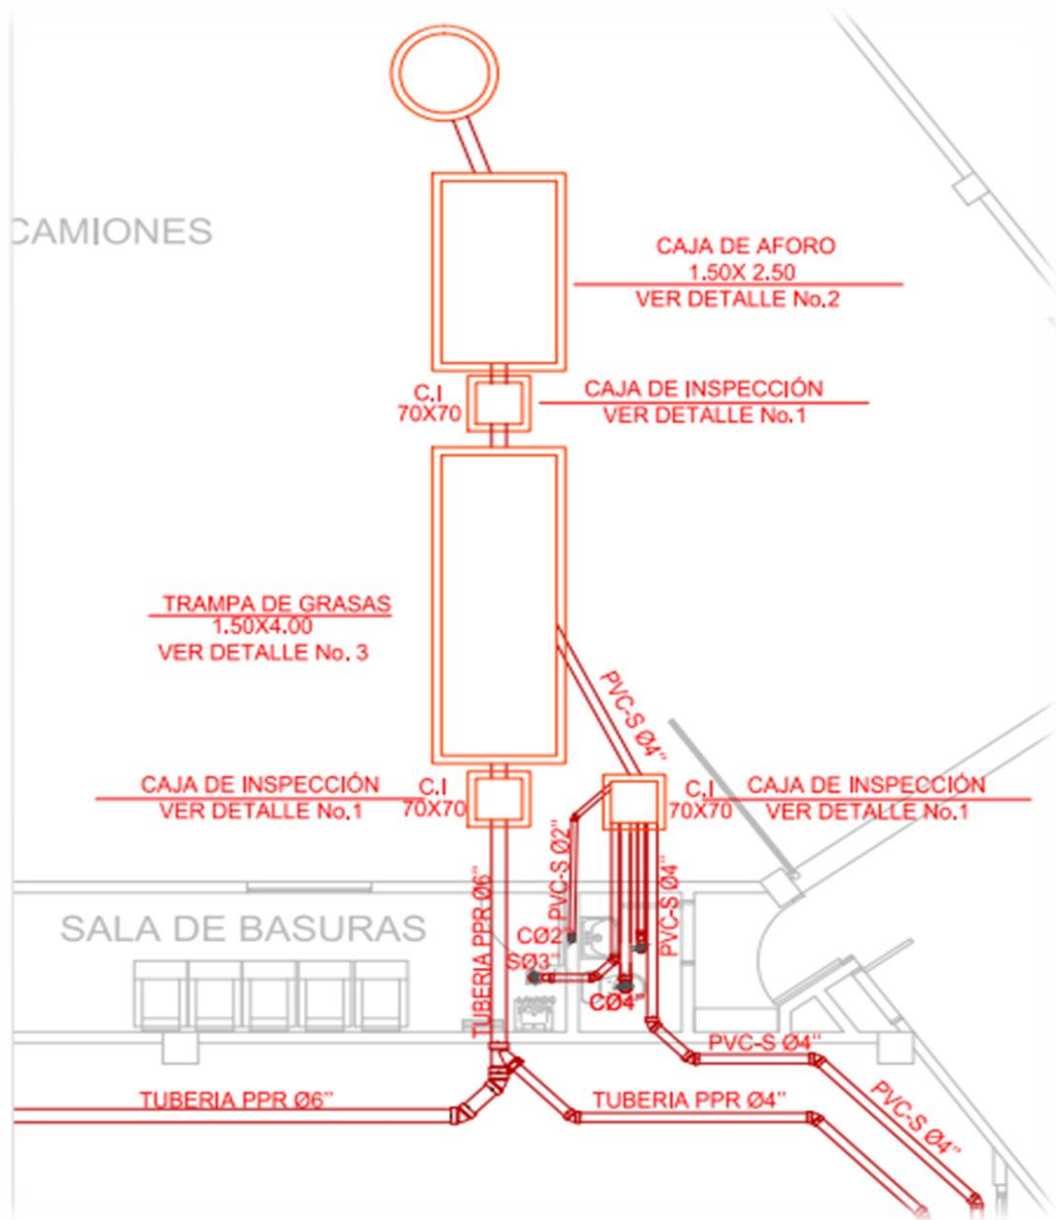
Vista en planta. Caja de Inspección, Trampa de Grasas, Caja de Aforo
